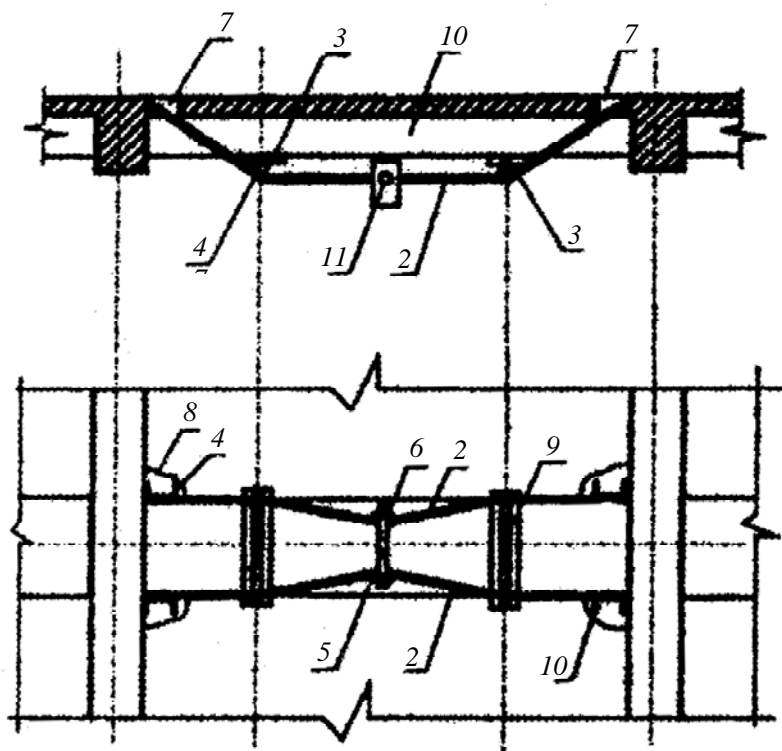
Усиление балки дополнительной предварительно напряженной арматурой (комбинированные затяжки):
